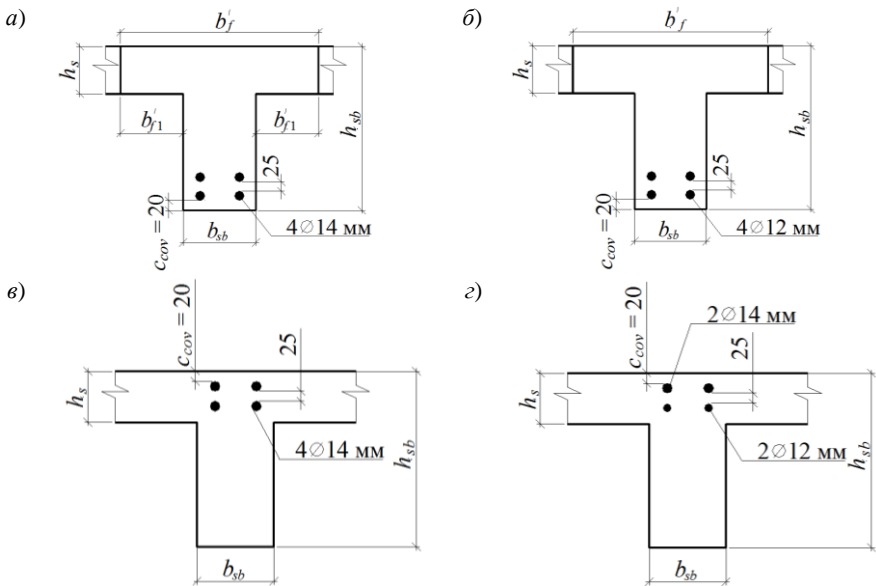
Расчетные сечения второстепенной балки с продольным армированием:
